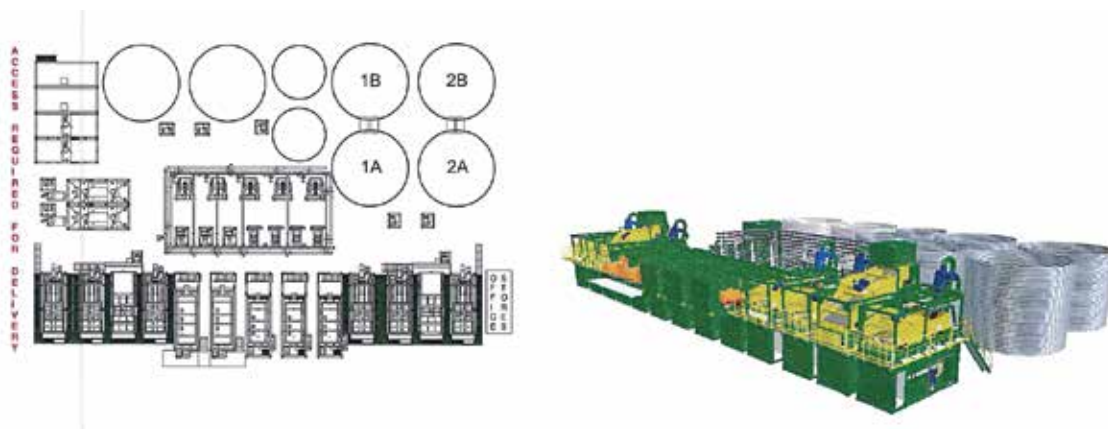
Vista en planta y vista 3D de una planta de tratamiento de lodos para dar servicio a 2 tuneladoras simultáneamente
